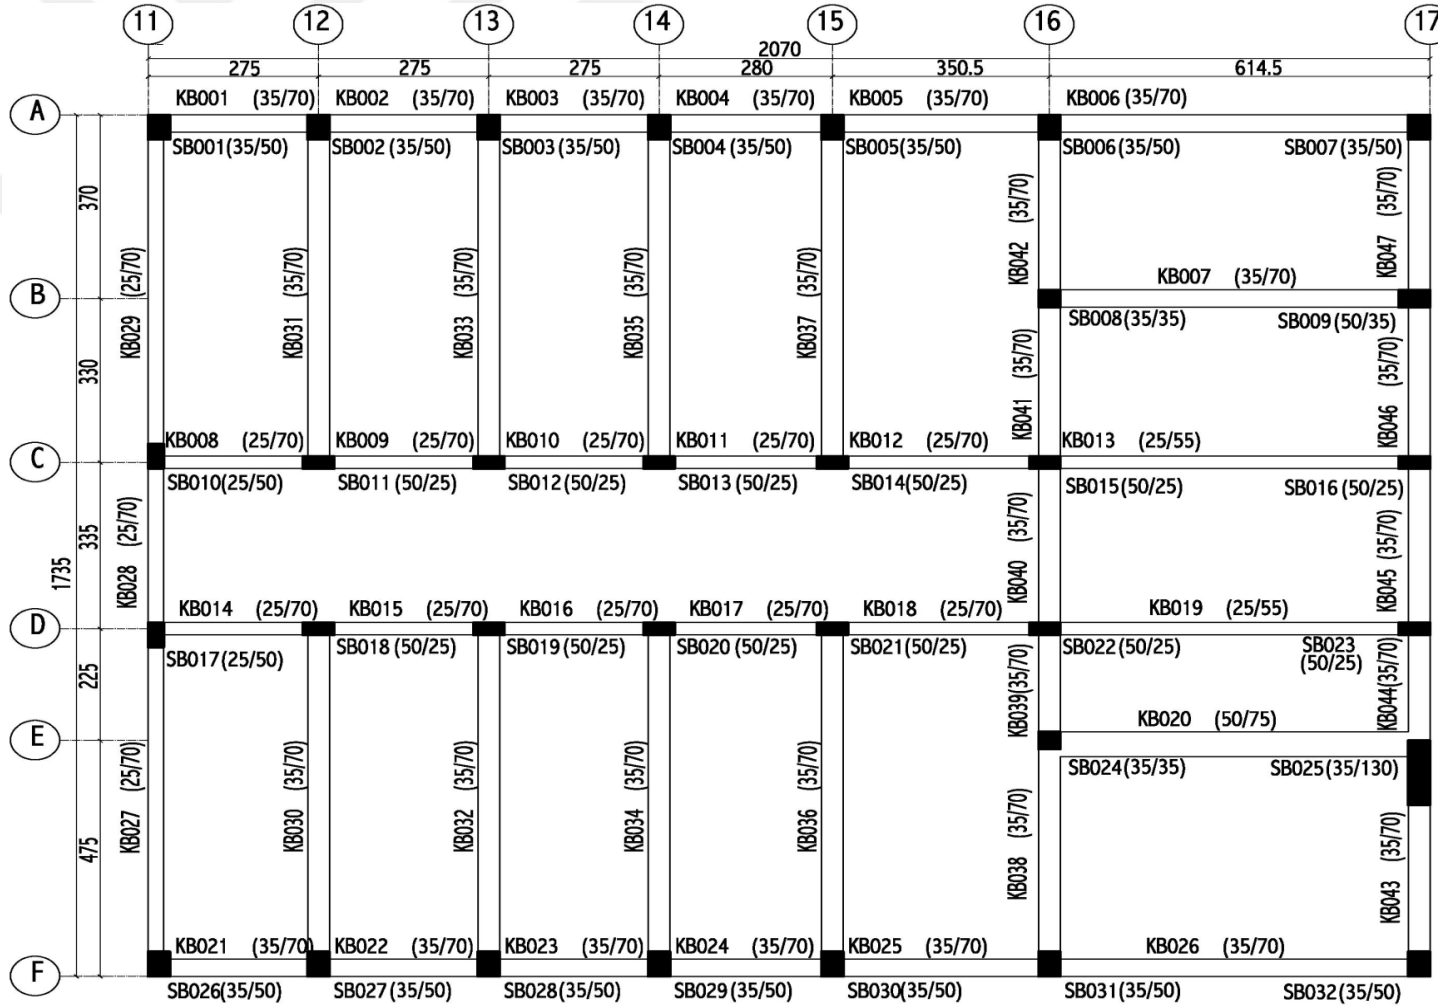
Zübeyde Hanım İlköğretim Okulu-A Blok kalıp planı
